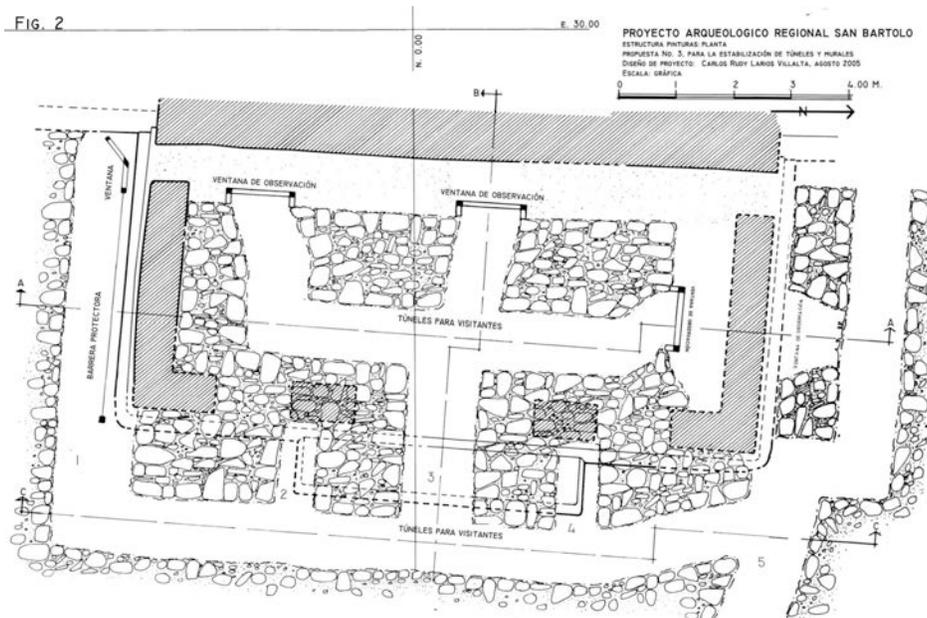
Planta arquitectónica, propuesta de túneles 2006. Dibujo: R. Larios.
